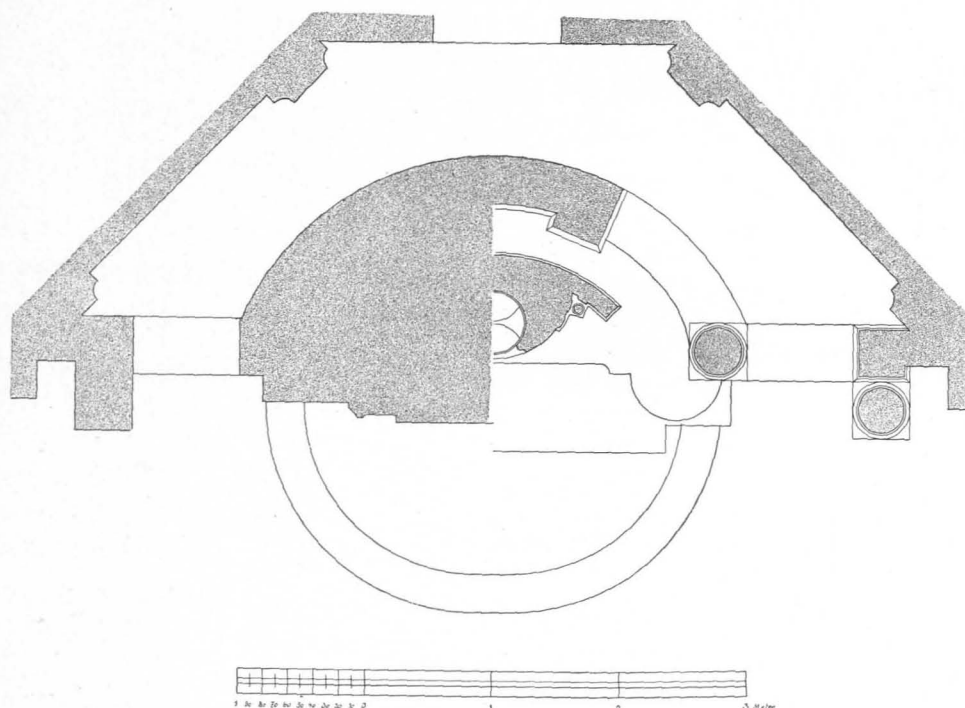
Köstendorf, Pfarrkirche, Grundriß des Hochaltars 1 : 60 (S. 90)
